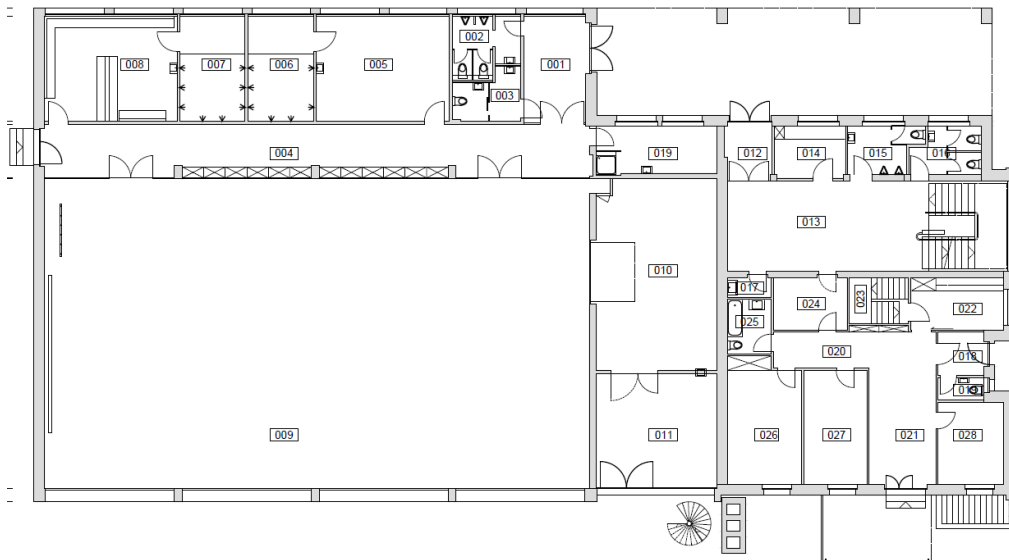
Hallentrakt H1 – Erdgeschoss IST
